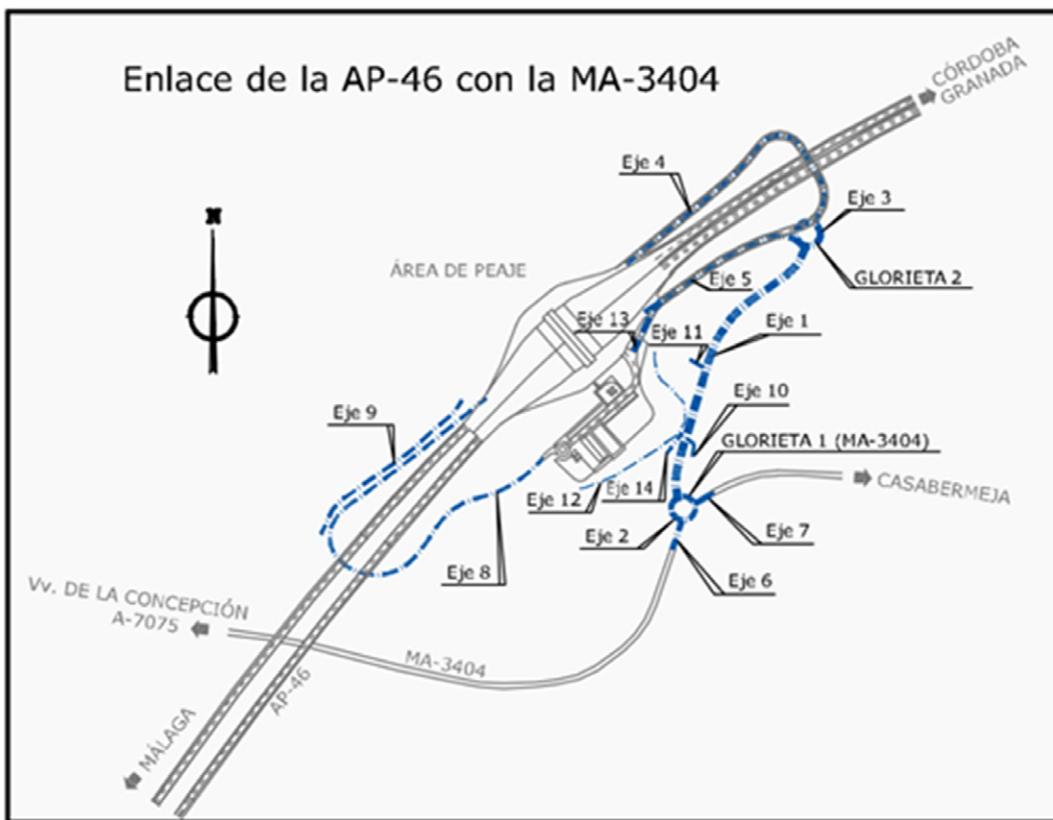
Nueva conexión entre la autopista AP-46 y la MA-3404 (alternativa 3)
